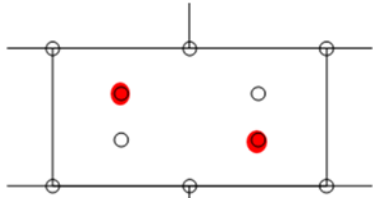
Plans de chevillage - panneaux de dimensions 1200 x 600 mm
